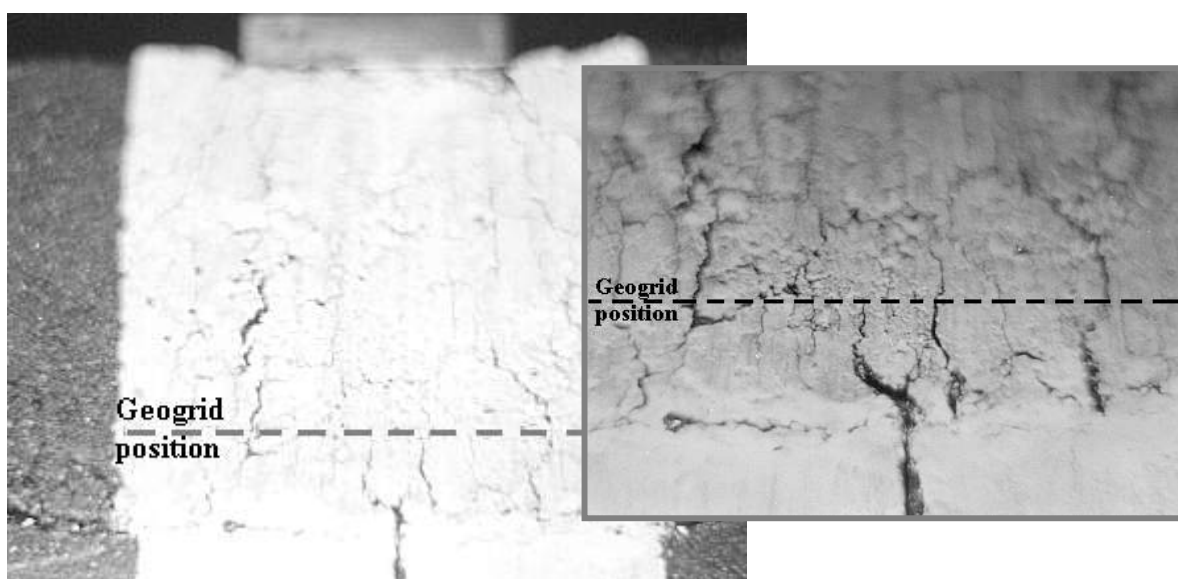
Microfissuração observada nas vigas com a geogrelha de poliéster Hatelit C 40/17 (flexão).
